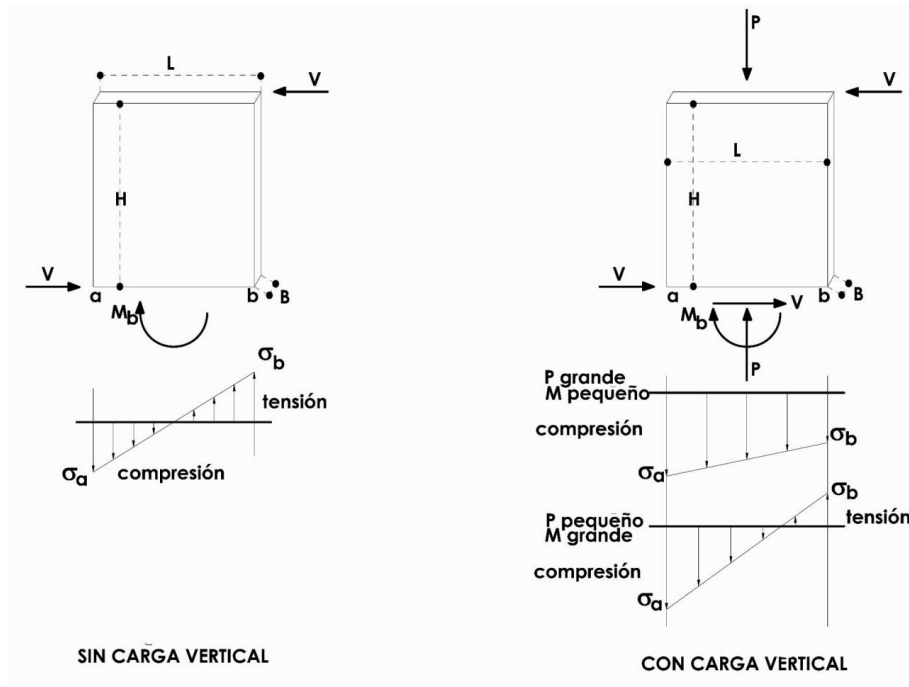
Estado de esfuerzos en la base de un muro de mampostería no reforzada
